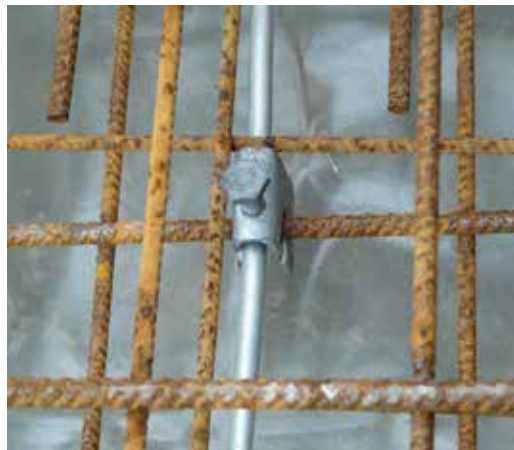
Ausführungsbeispiel für Fundamenterder in der unteren Bewehrungslage
